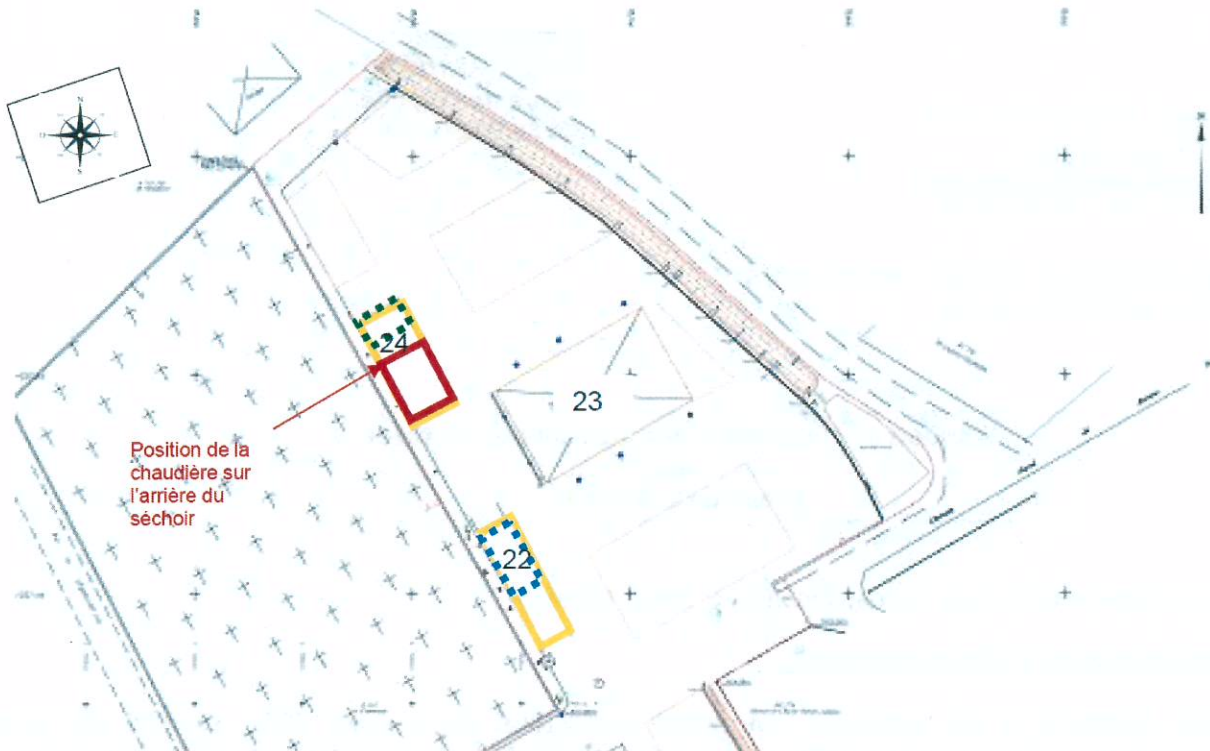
position actuelle des séchoirs sur le site et projet d'implantation du nouveau séchoir.
